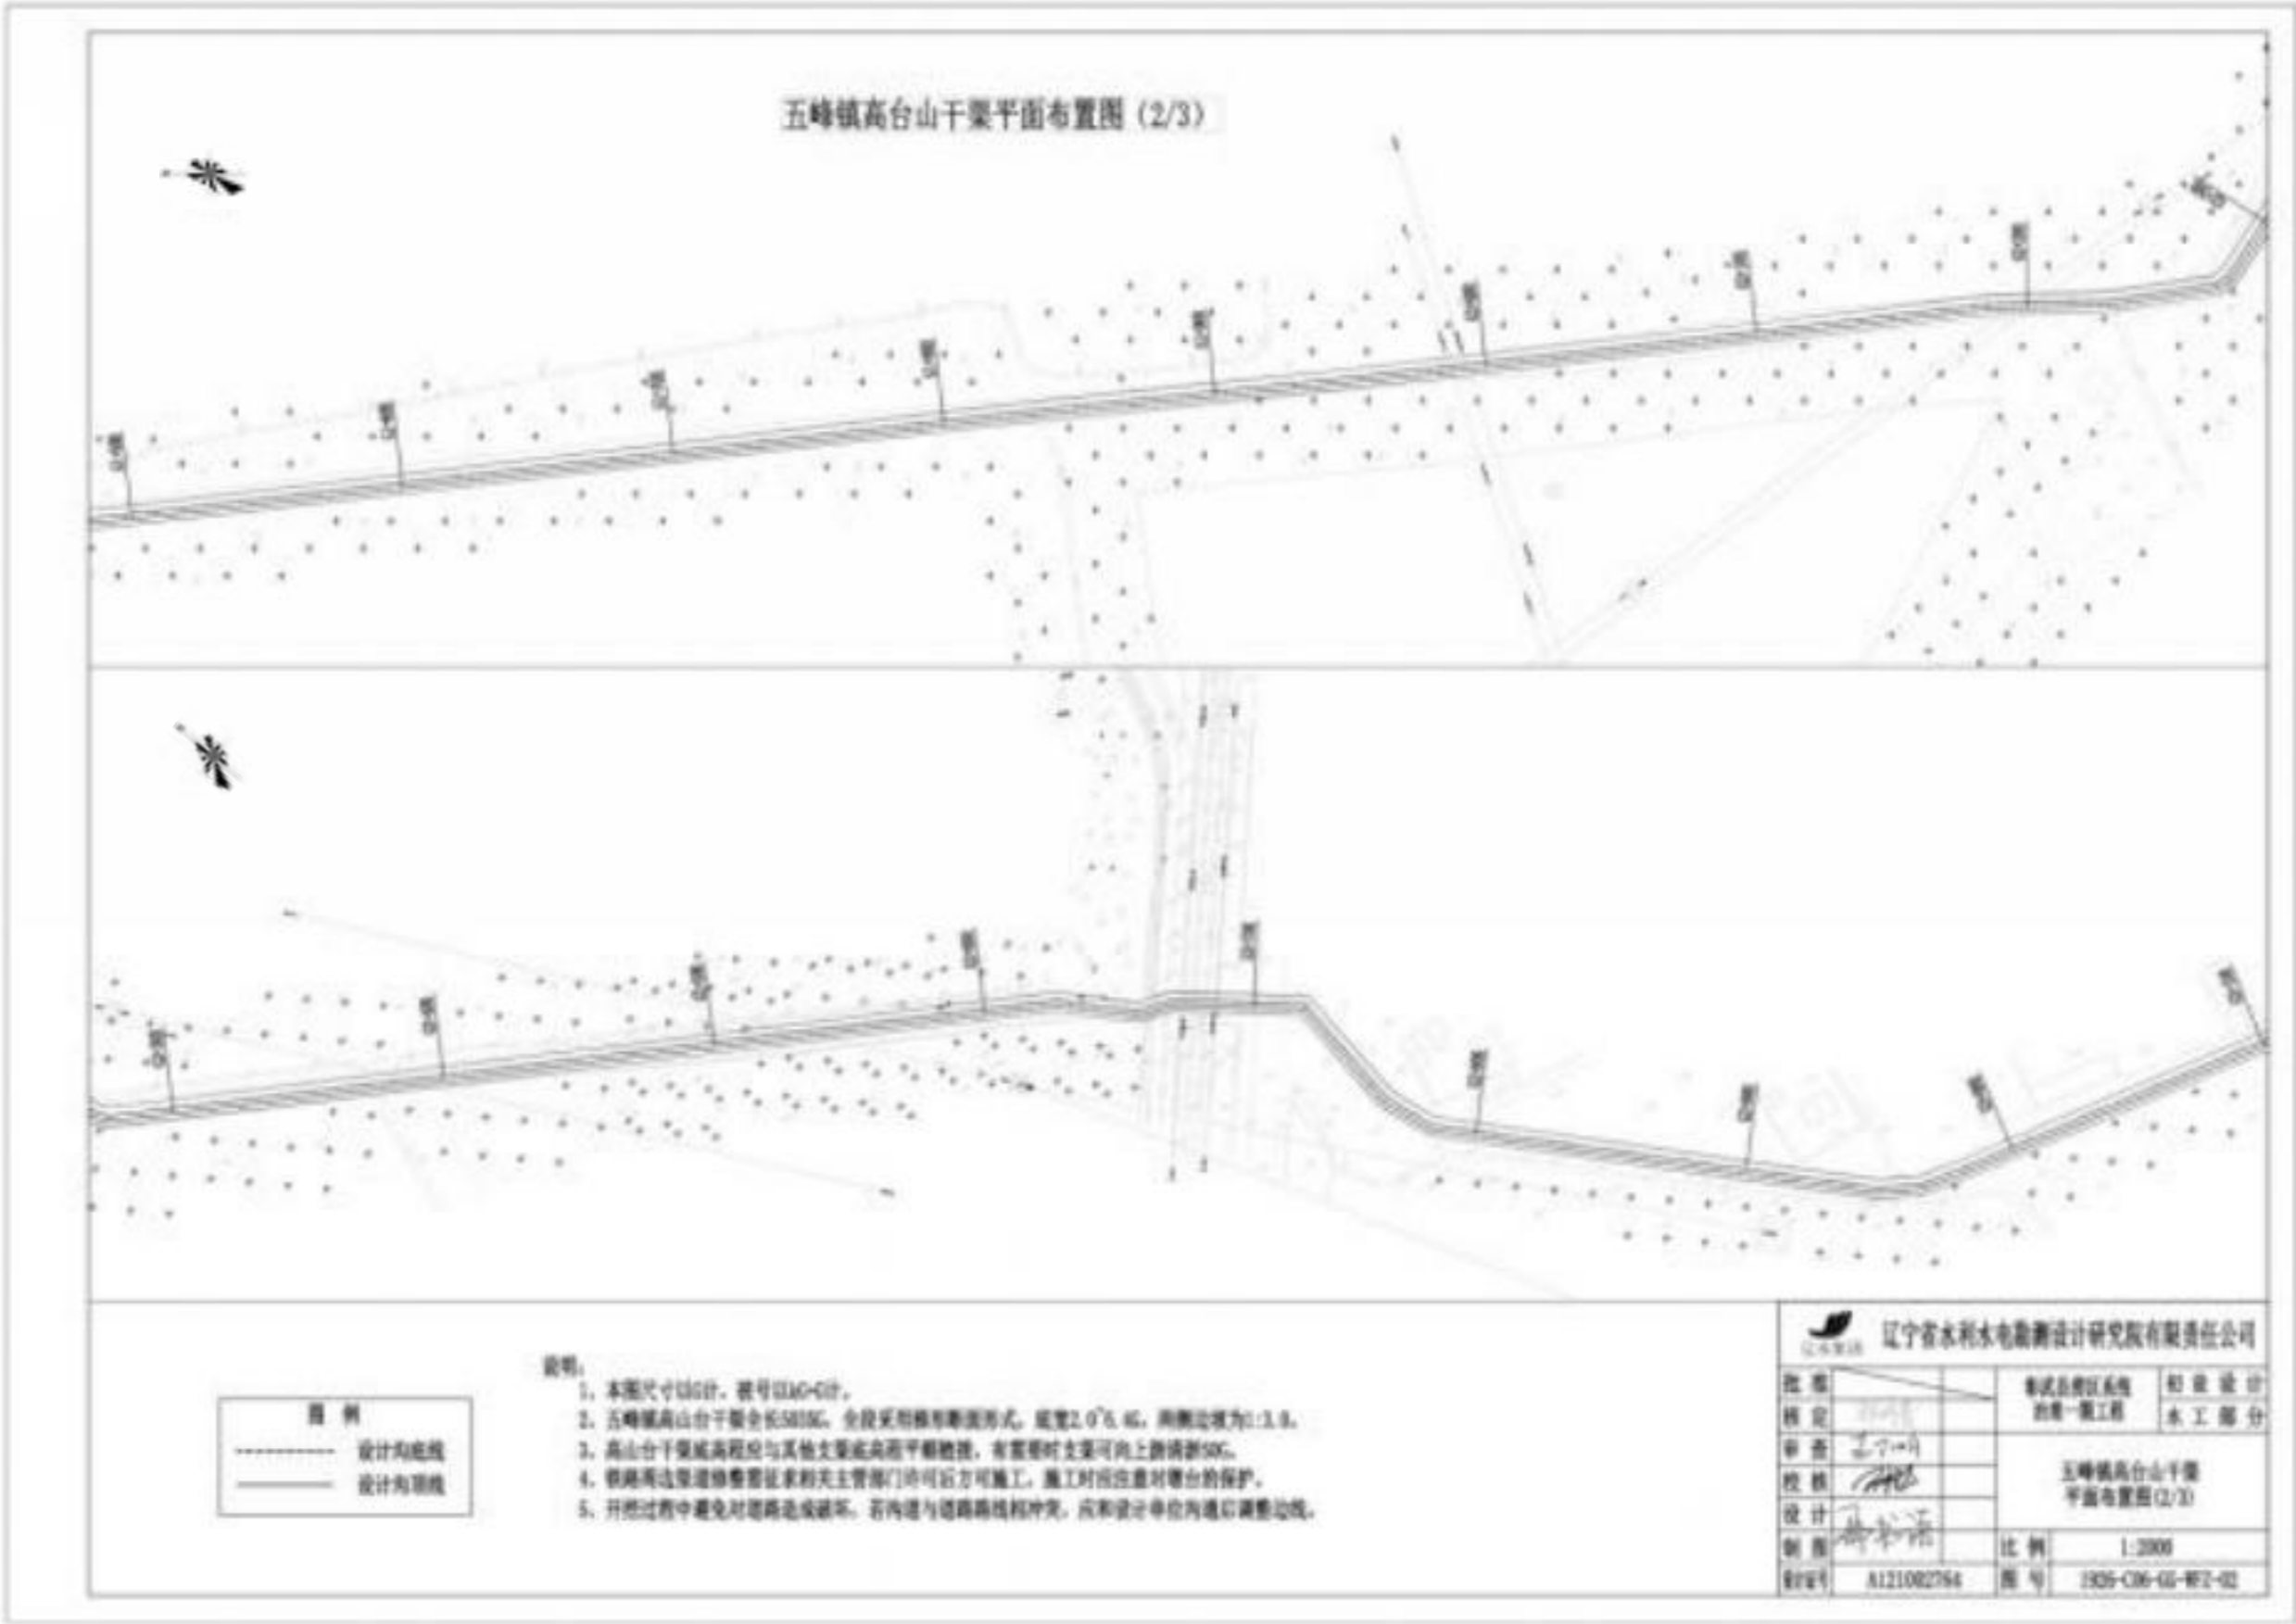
(2) 五峰镇高山台干渠平面布置图
